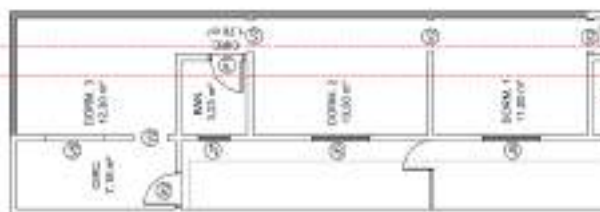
Planta dos cômodos que serão afetados pela requalificação do reboco.
